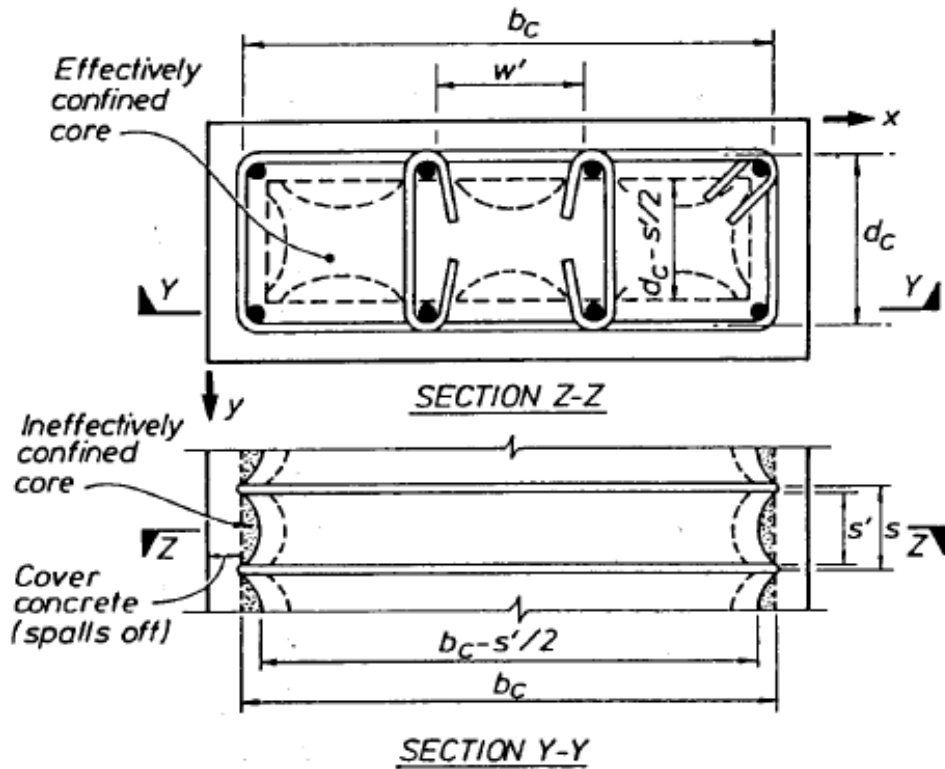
Schema delle zone confinate e non in una sezione rettangolare
